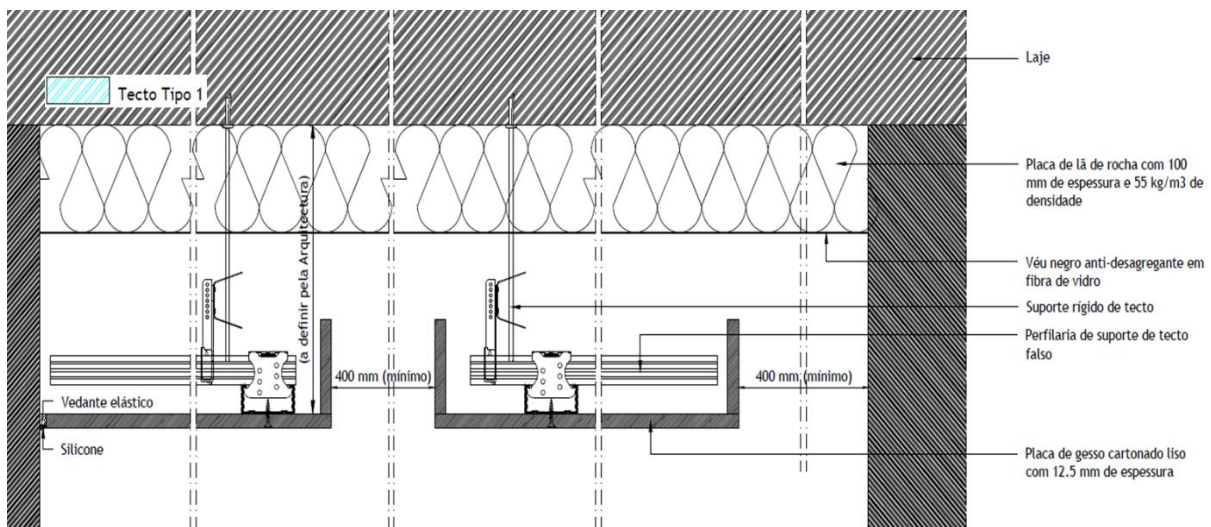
Pormenor construtivo do teto aplicado em corredores da Escola Secundária de Gondomar [53].
